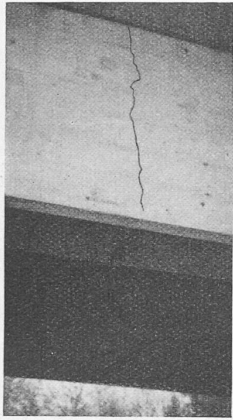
Hauptträger der Brücke Abb. 4. Riss verschwindet in der Nähe d. Hauptarmierung
